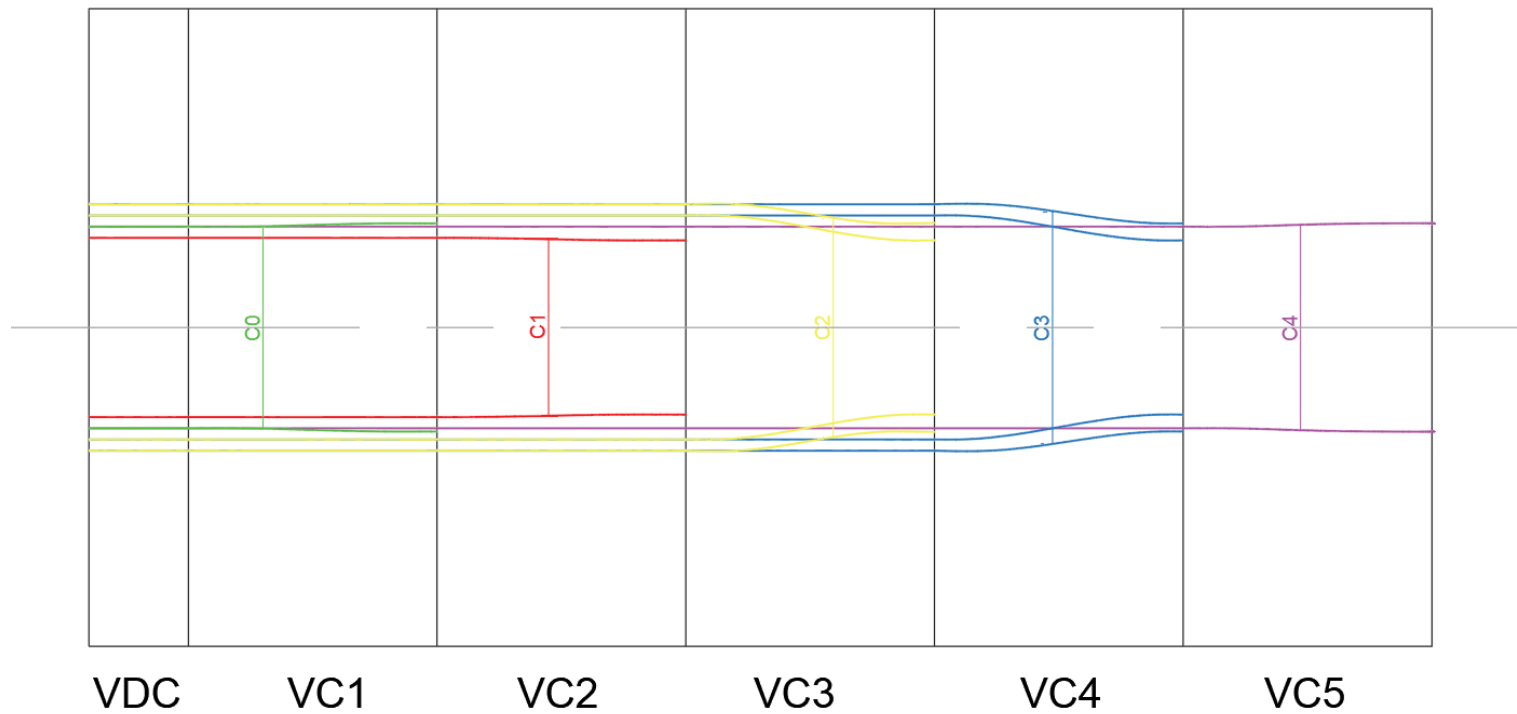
Tracé en plan des câbles de continuité en travée principale
